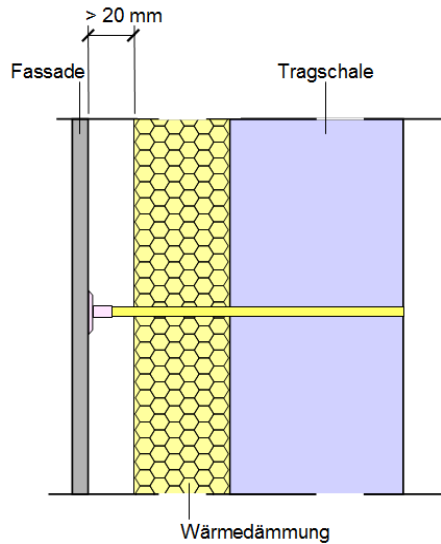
Die Querschnittstiefe des Hinterlüftungsraumes soll mindestens 20 Millimeter betragen.
